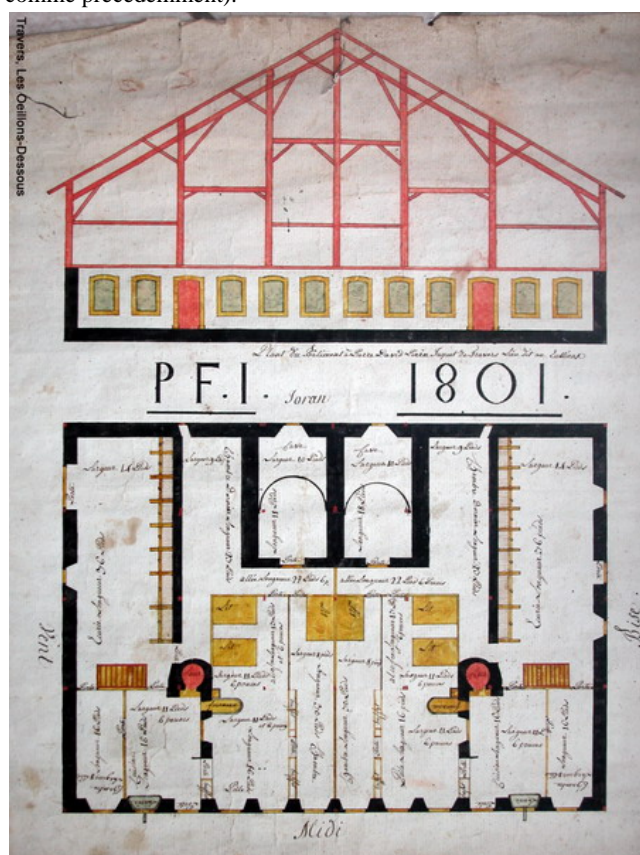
Plan d'une ferme à pignon frontal de 1801, aux Oeillons sur la commune de Travers.
